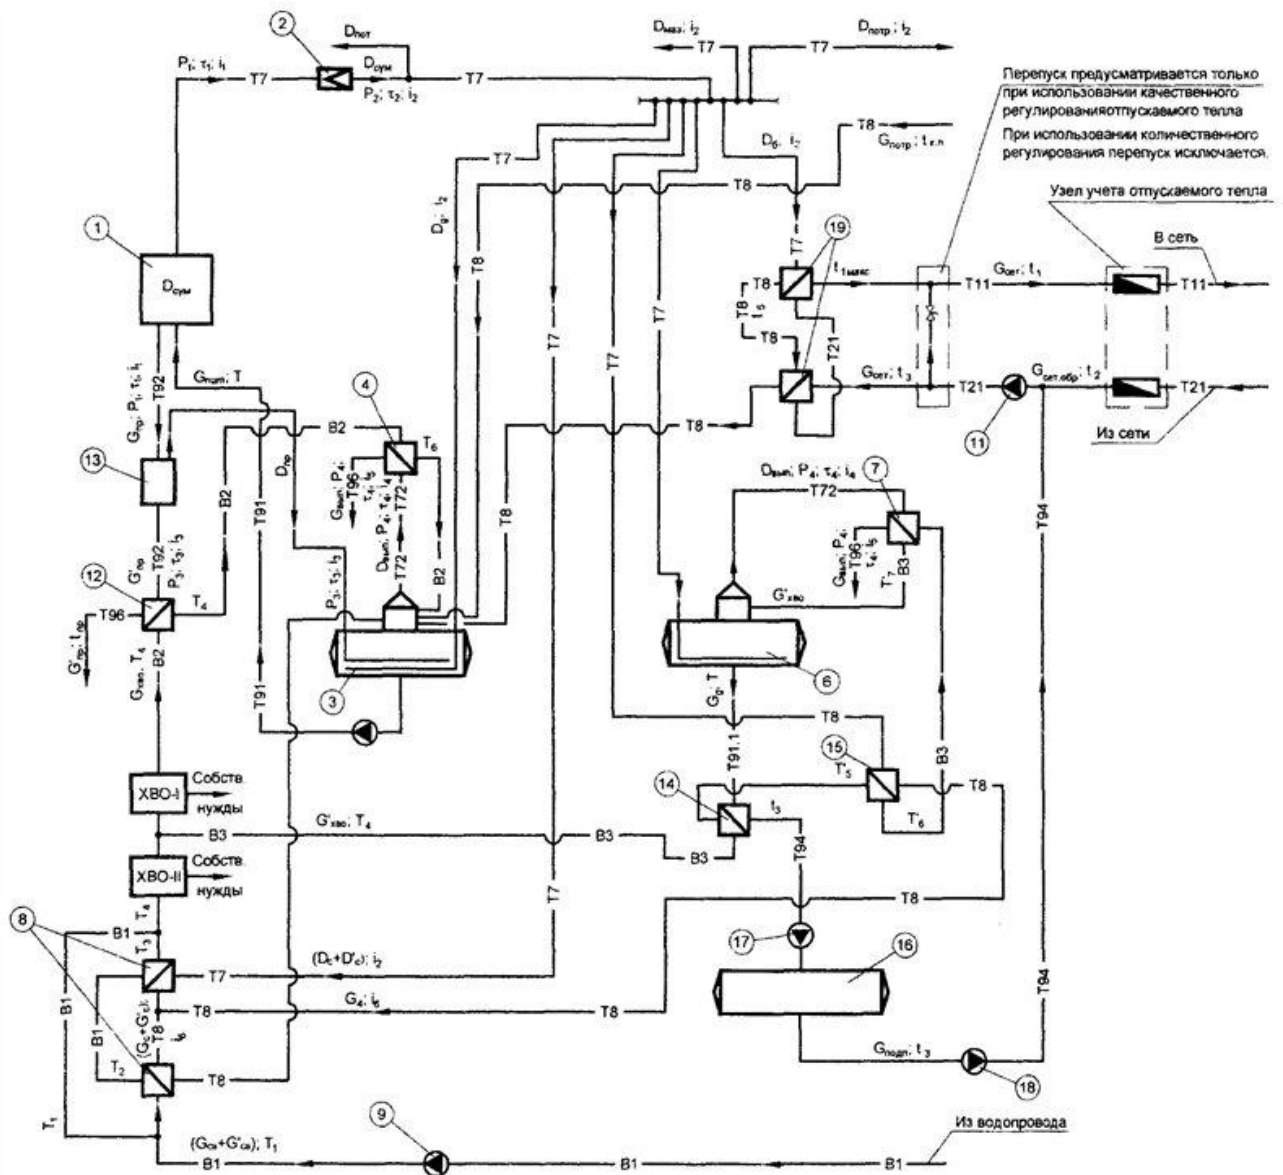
Расчетная тепловая схема отопительно-производственной котельной с паровыми котлами ДЕ для открытой системы теплоснабжения:
